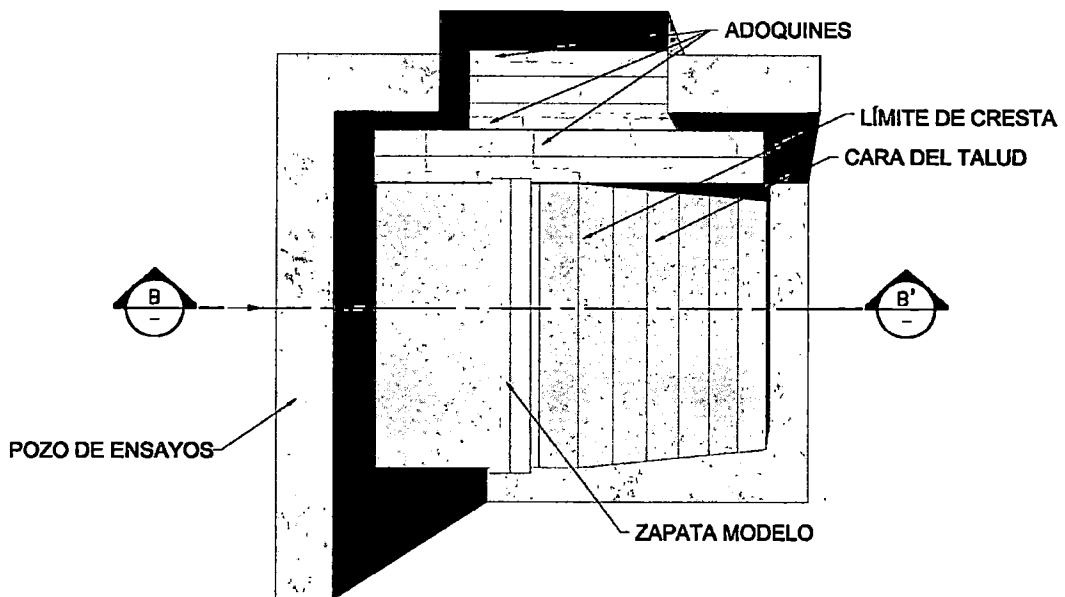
Vista en planta típica - Modelo TSR en tres dimensiones
